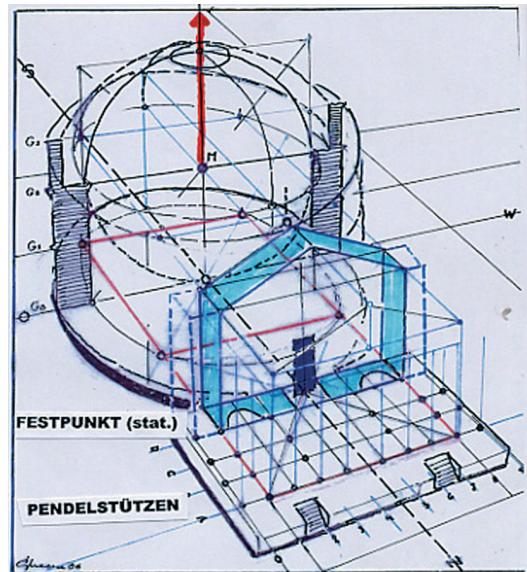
Pantheon II. Grundrissgeometrie und dritte Dimension.
